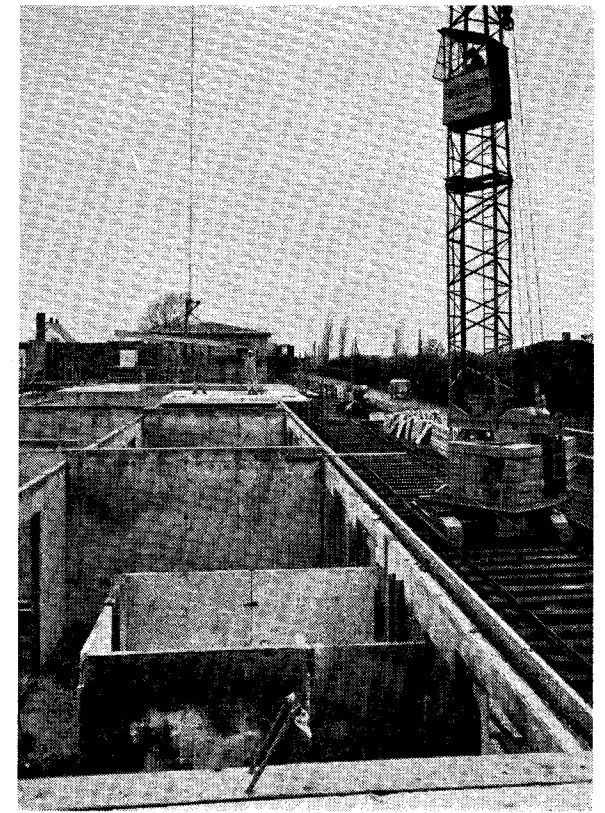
Sidegangshus ved Strandhavevej. Elementbyggeri, hvor færdigfabrikerede vægge om baderum må opstilles inden de præ-fabrikerede etageplader kan lægges på plads.
